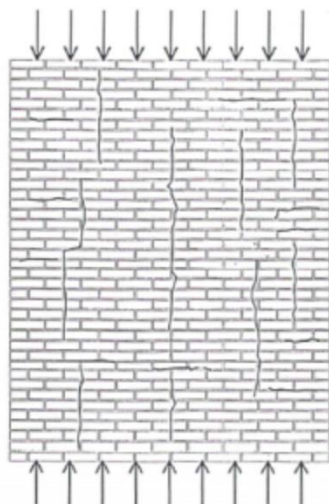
Fissuras verticais por sobrecarga em parede de alvenaria
